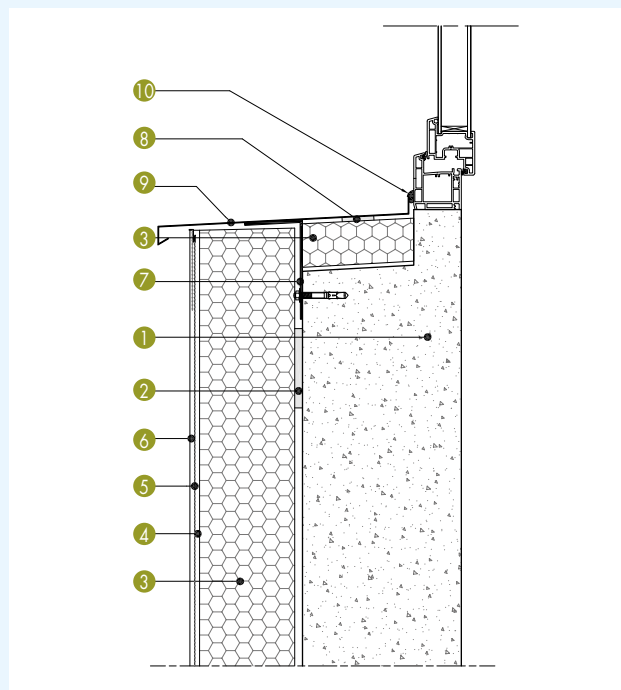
Coupe sur baies en service - appui maçonné trop court (coupe verticale)
